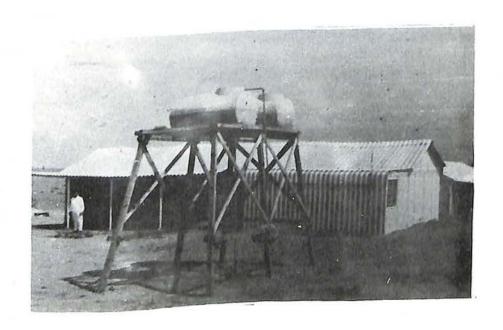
DETALLE DE LOS TINACOS Y AL FONDO LA CASA DE INGENIEROS.
